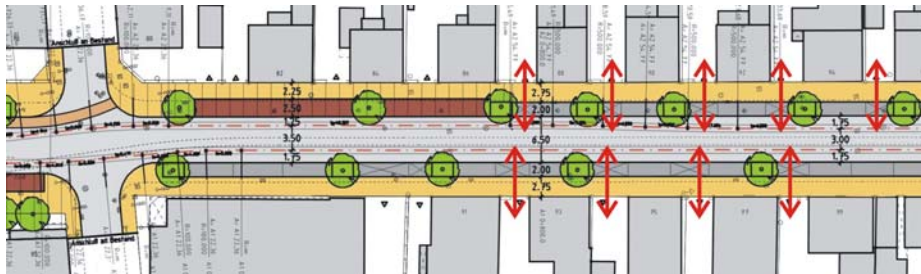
Lageplan „Sichtbehinderung durch parkende Fahrzeuge“
